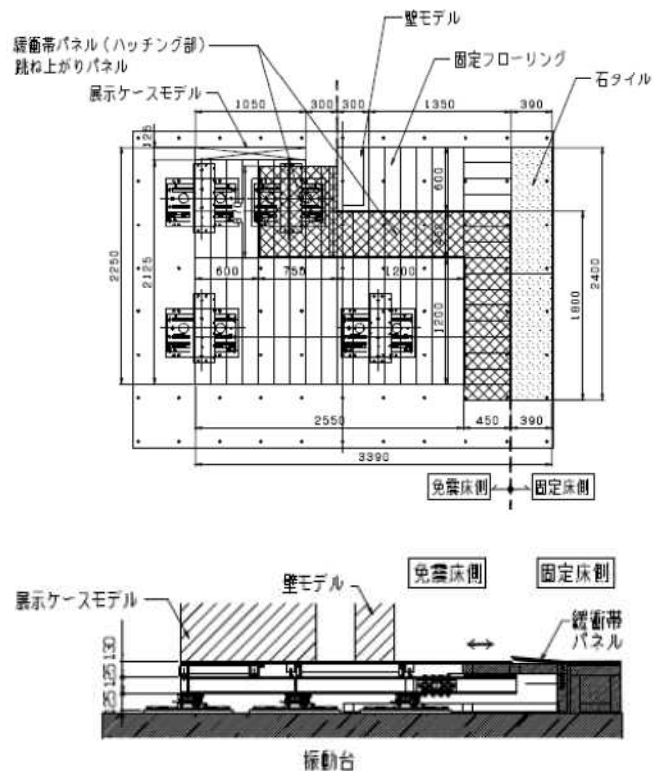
緩衝帯パネル部 断面・平面詳細図（試験体）
